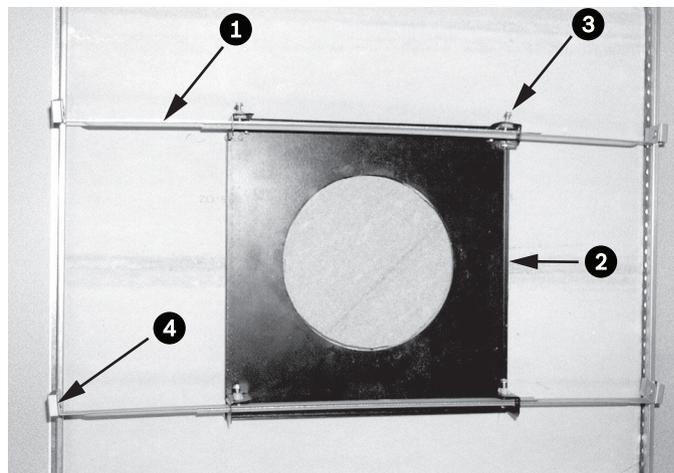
Suporte de suspensão para tecto falso (vista superior)
